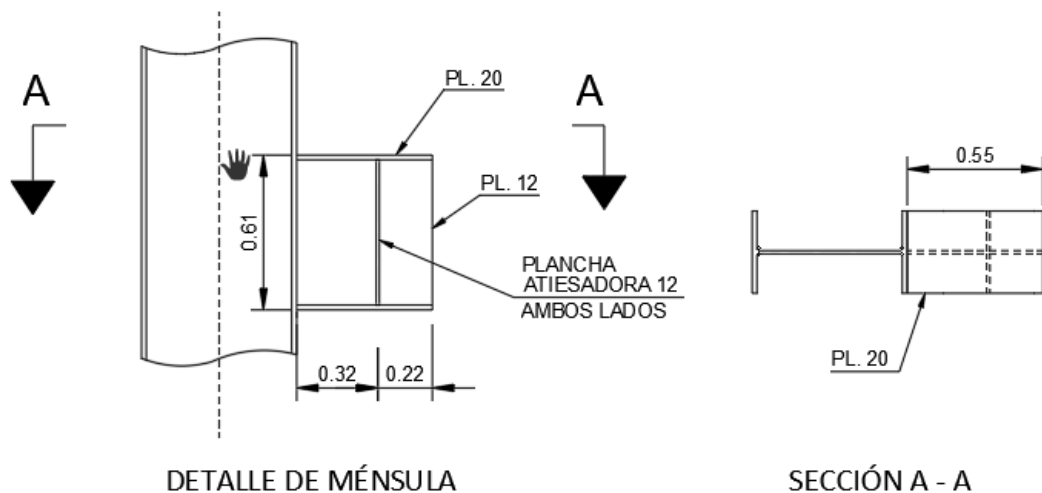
Detalle de ménsula de soporte de viga carrilera.
